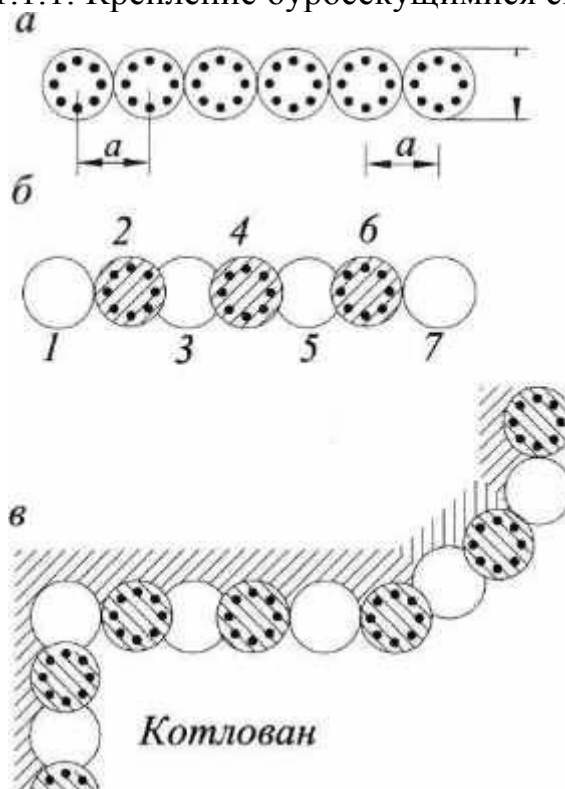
Схемы формирования «стены в грунте* из буронабивных свай: а - стена из примыкающих свай; б - стена из пересекающихся свай; в - угловой элемент «стены в грунте*»: 1,3,5,7 - сваи первой очереди; 2, 4, 6 - сваи второй очереди
